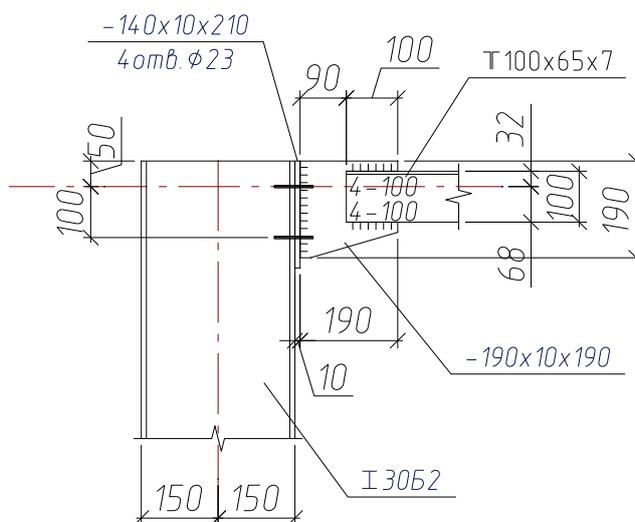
Узел примыкания верхнего пояса с надколонником
